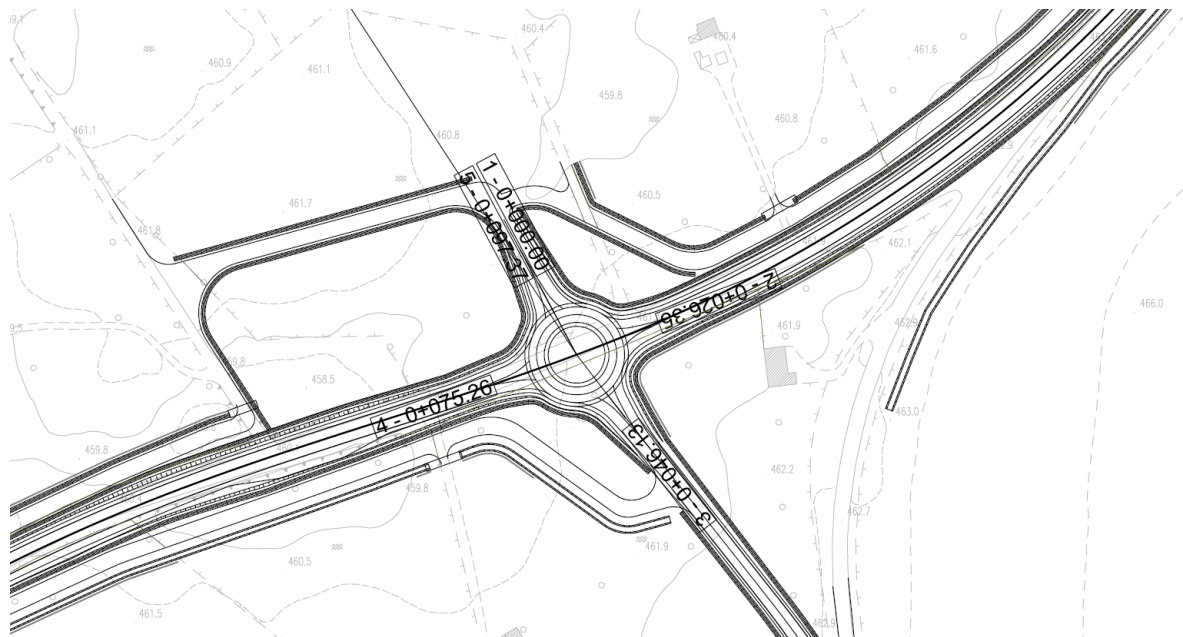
Planimetria di progetto Rotatoria 9- Km 16+749,30
